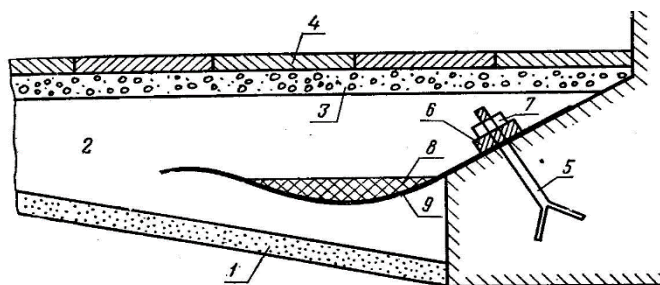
Стык понура с фундаментной плитой плотины:
